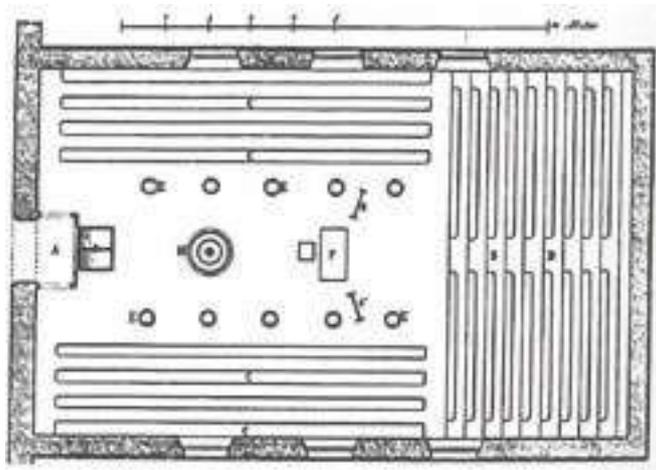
Der Grundriss eines Kleinkinder-Schulzimmers orientiert sich an einer Architekturempfehlung aus dem Jahr 1863. Dabei werden ein Lehrerpult, Bänke, eine Galerie und Lektionspfosten verwendet, um den Raum zu strukturieren.
